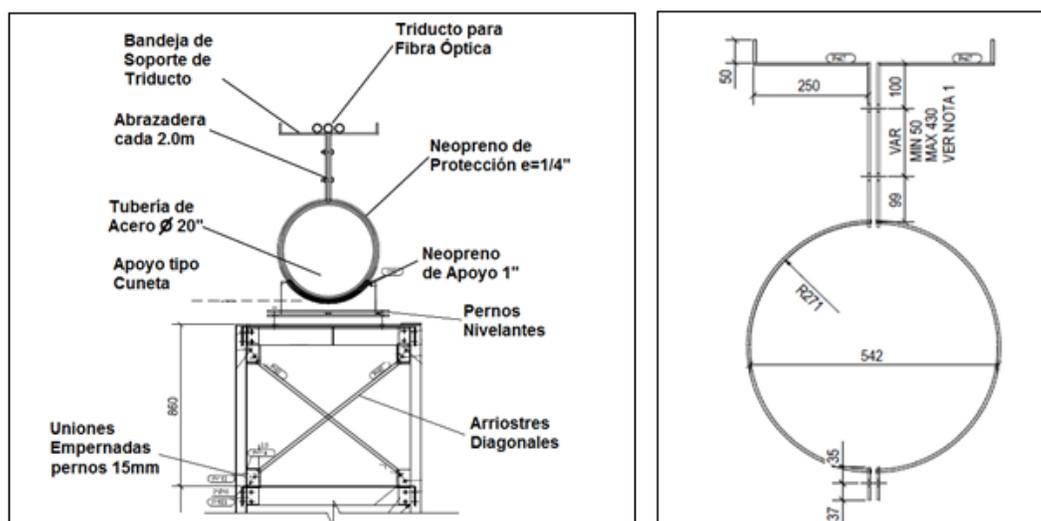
Destalles de Soporte Metálico para Tubería y triducto
